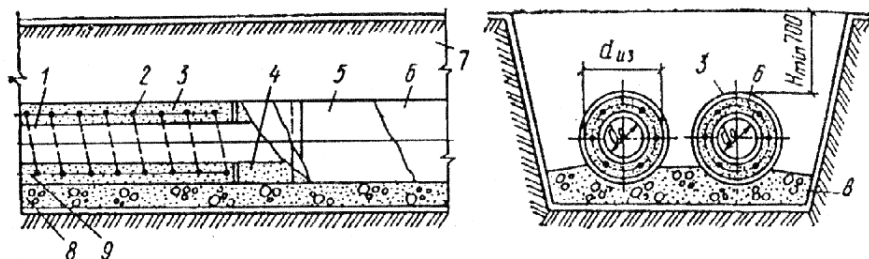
Прокладка трубопроводов в изоляции из монолитного армопенобетона
